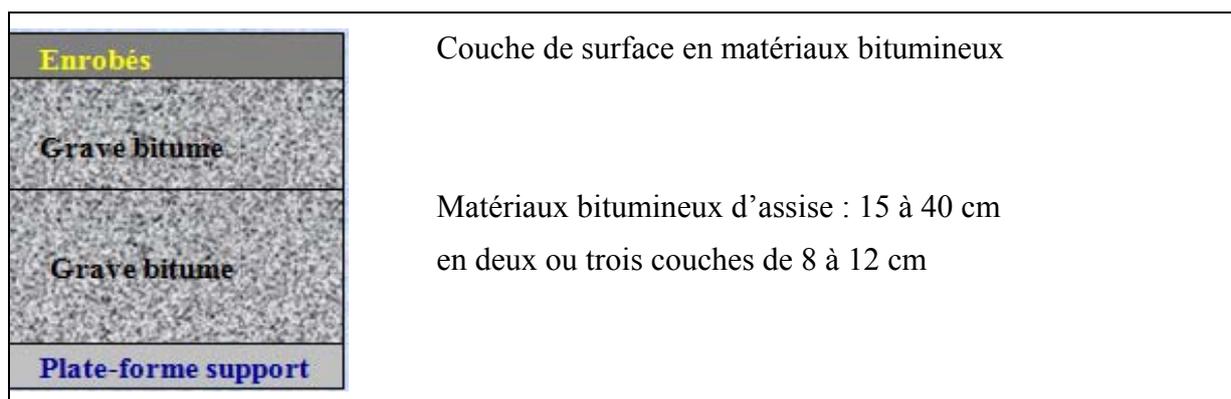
Structure d’une chaussée bitumineuse épaisse.(catalogue de structure type de chaussée, LCPC,1994)
